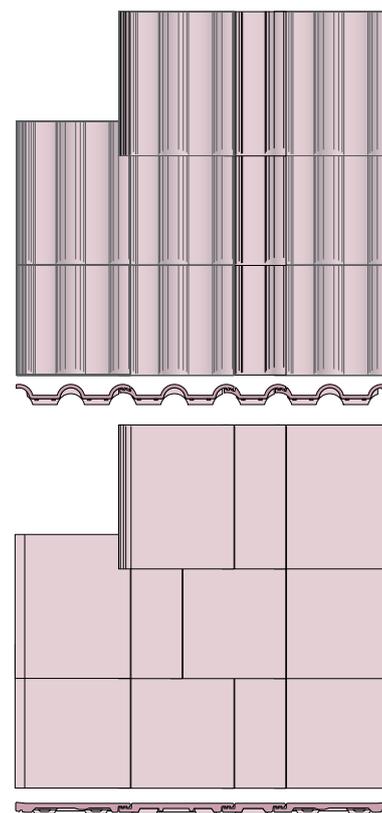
/602: Tuile béton profilée (en haut), tuile béton plate (à droite)
